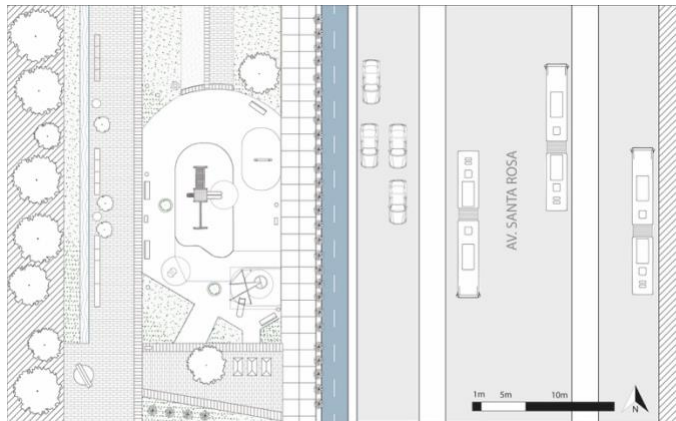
Plano emplazamiento plaza "B". Fuente: Elaboración propia
